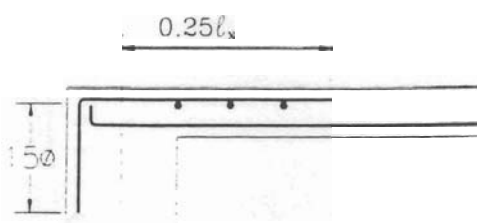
Detalhe de armadura negativa nas lajes de extremidade
